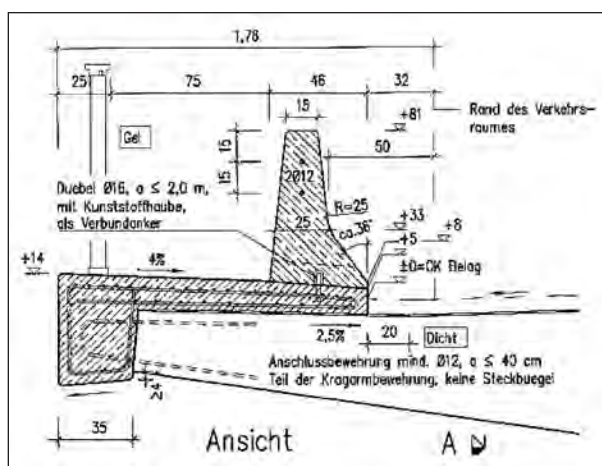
Richtzeichnung Kap 11: Einseitige Betonschutzwand in Ortbetonbauweise auf Brücken
